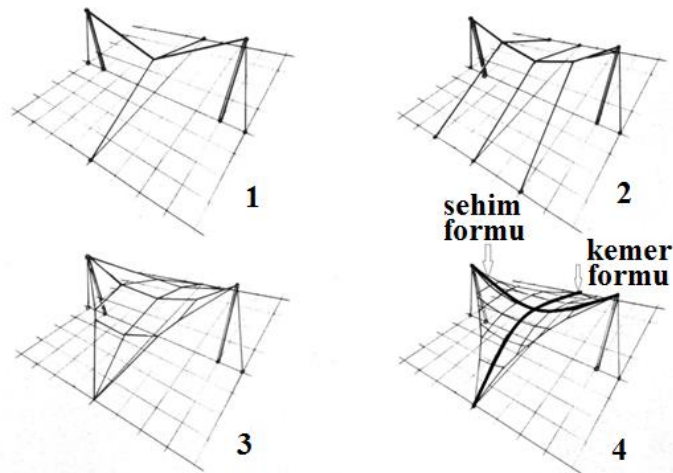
The Adirondack Bank Center binasının çatı kurgusu (Sābetghadam, 2019)
